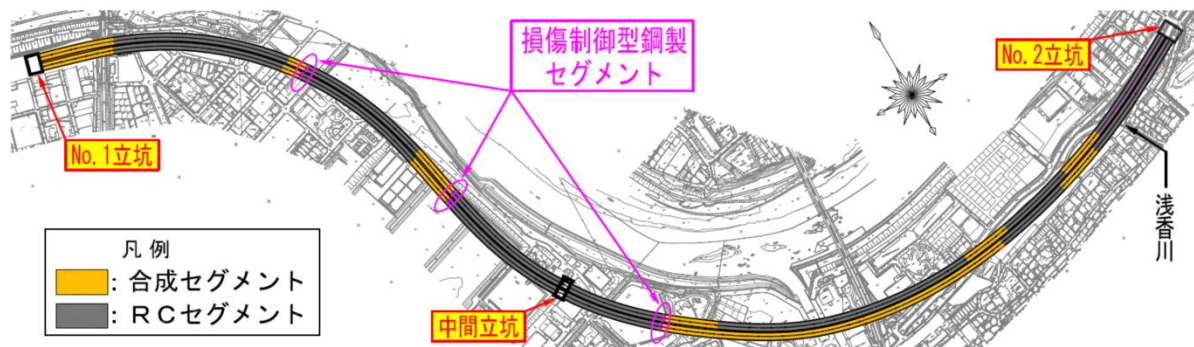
大和川線シールドトンネル (阪神高速道路(株)施工区間) 平面図
